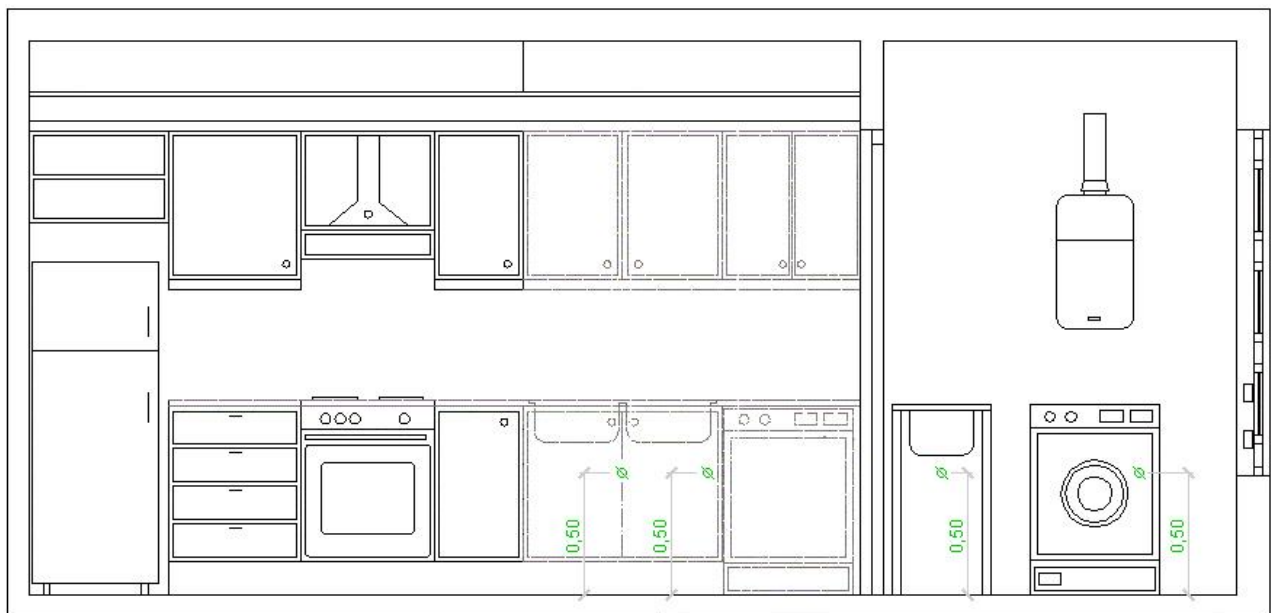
Esquema colocación aparatos sanitarios cocina. Alzado.
